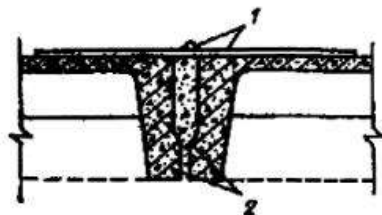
Узел молниеприемной сетки над местом соединения плит перекрытия:
